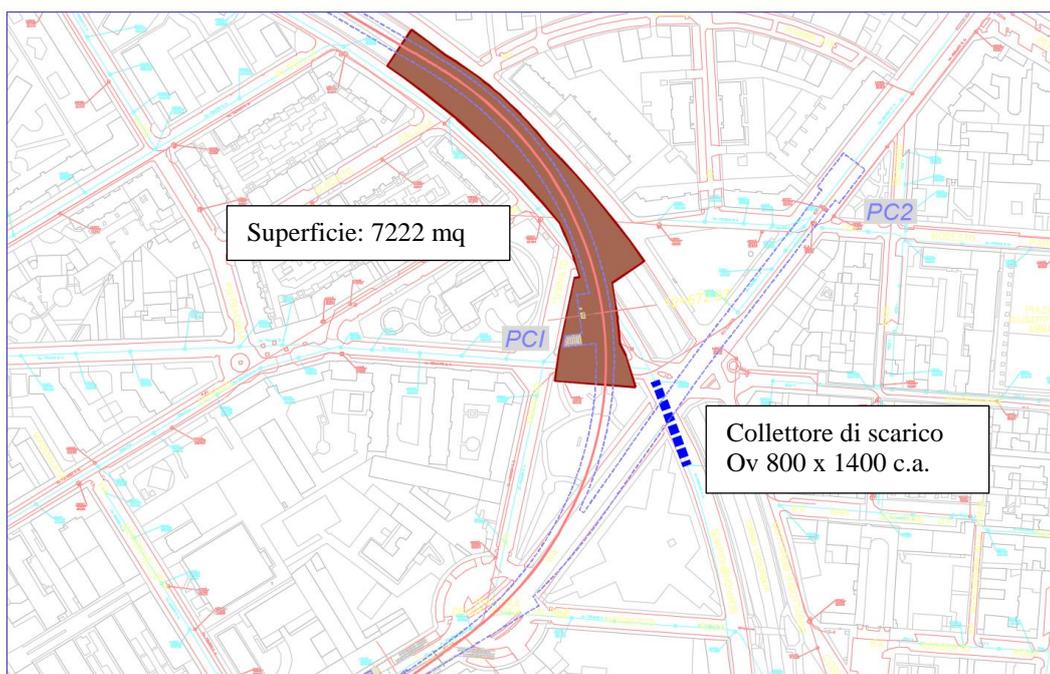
Aree di cantiere – Tratto Corelli - Cimarosa – FASE 1
